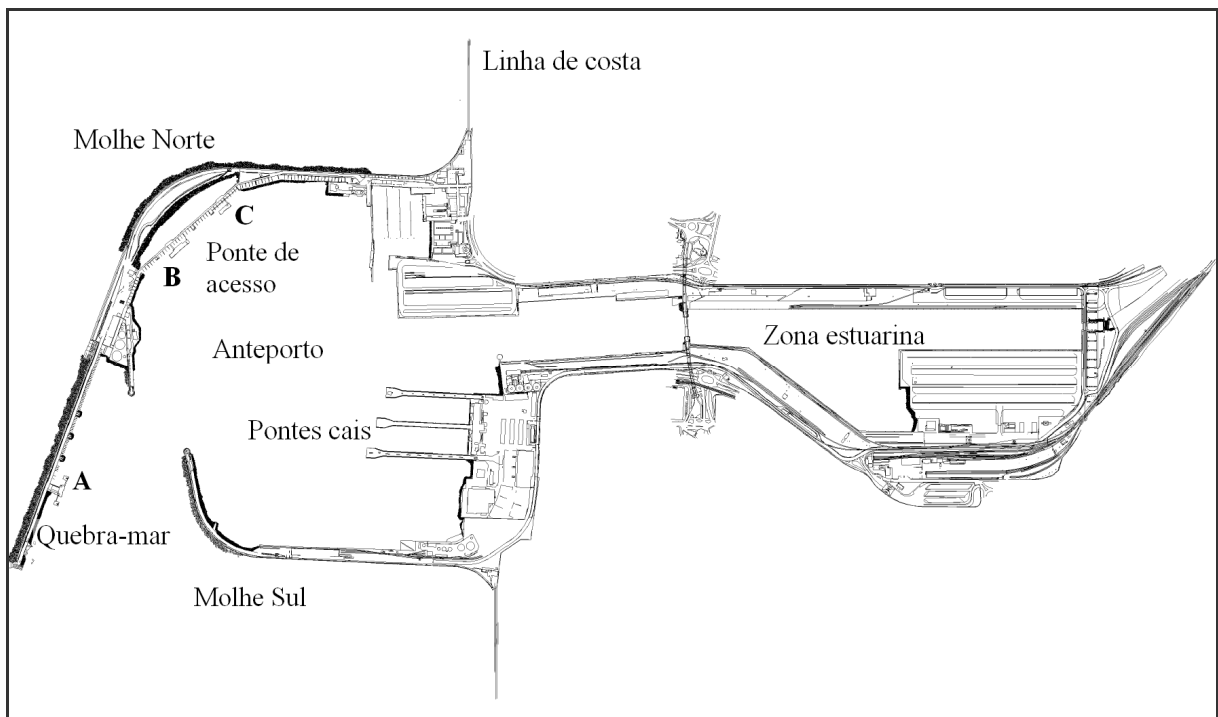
Planta geral do Porto de Leixões [3].
